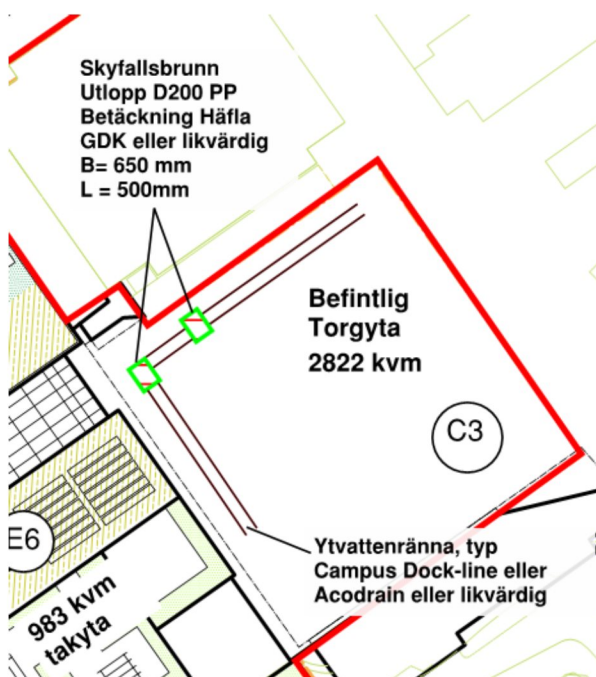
Avvattningsplan för utredningsområdet. Se bilaga 1 för större bild.
